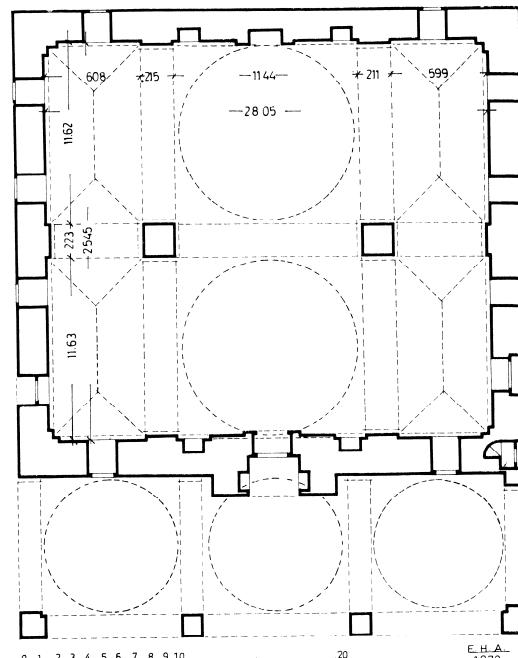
مسقط افقي لجامع بابا آدم في رامبال بالبنغال (M.Kiel
